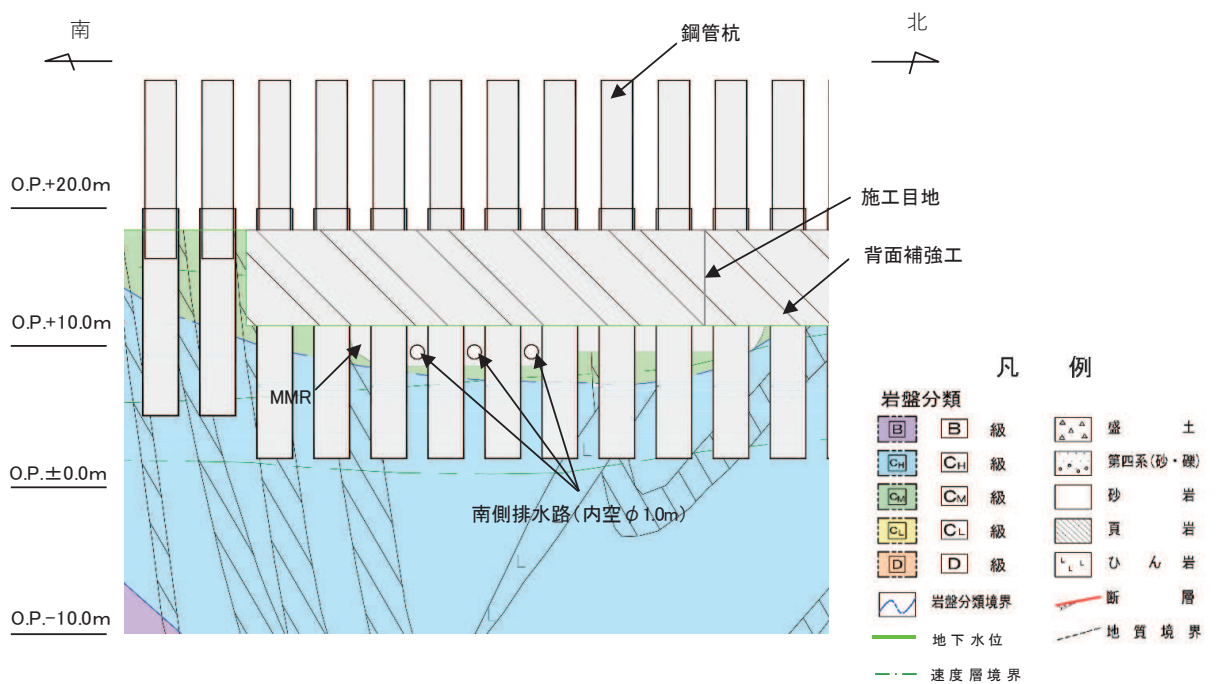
南側排水路評価対象断面図 (A-A' 断面)
